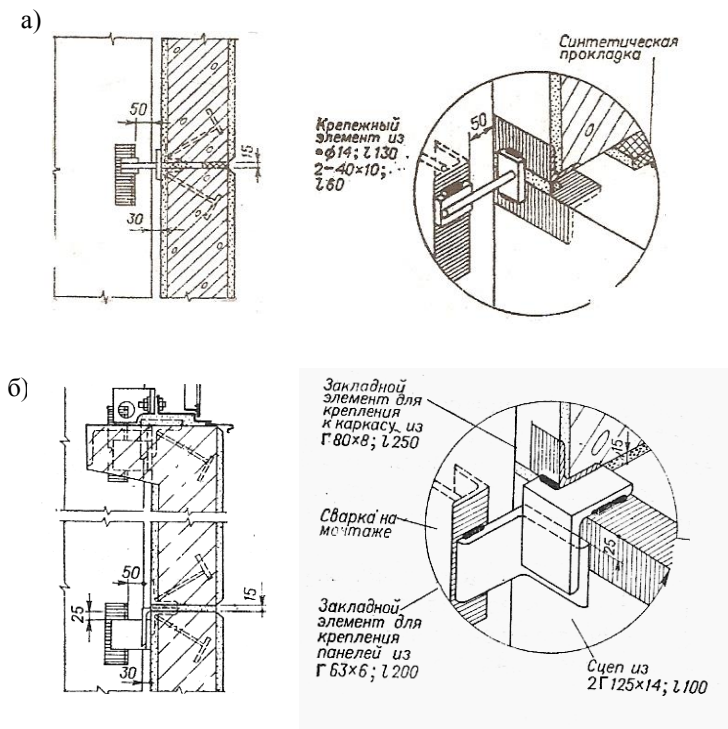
Навеска легкобетонных панелей на колонну:
